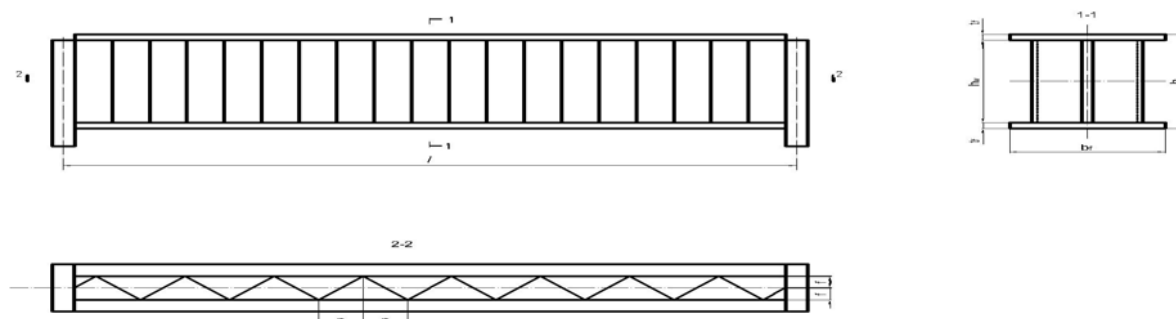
Схема балки с гофрированной стенкой: a – длина полуволны гофра; f – высота волны гофра; h – высота сечения балки; h_w – высота сечения стенки; t_w – толщина сечения стенки; b_f – ширина сечения пояса; t_f – толщина сечения пояса
